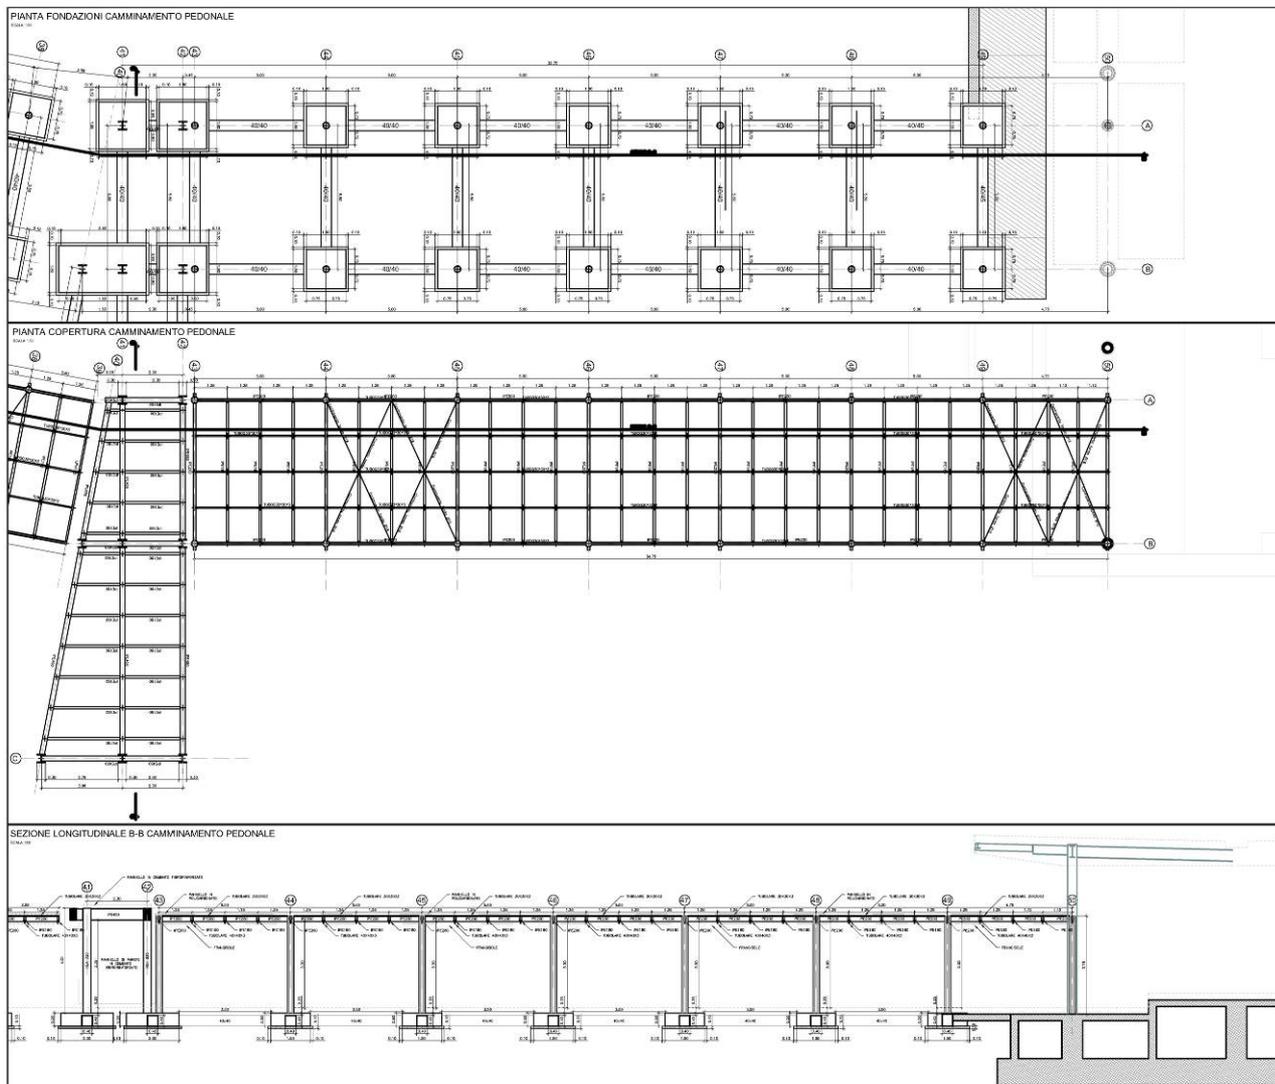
Pianta fondazioni, copertura e sezione longitudinale del camminamento pedonale
